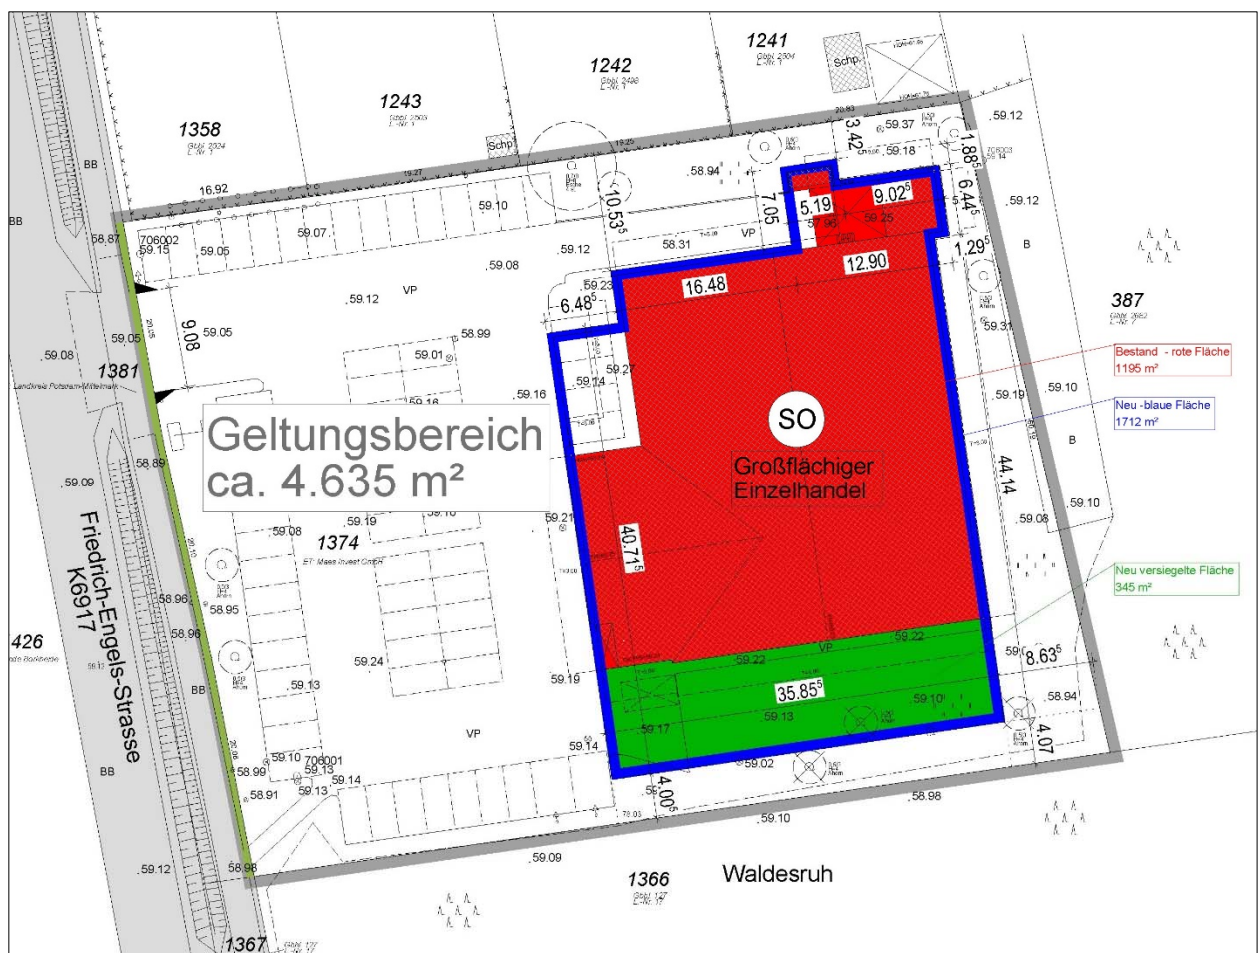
Ausschnitt B-Planentwurf mit Darstellung der geplanten Erweiterungen; Planungsbüro Hirt Rathenow 2024
